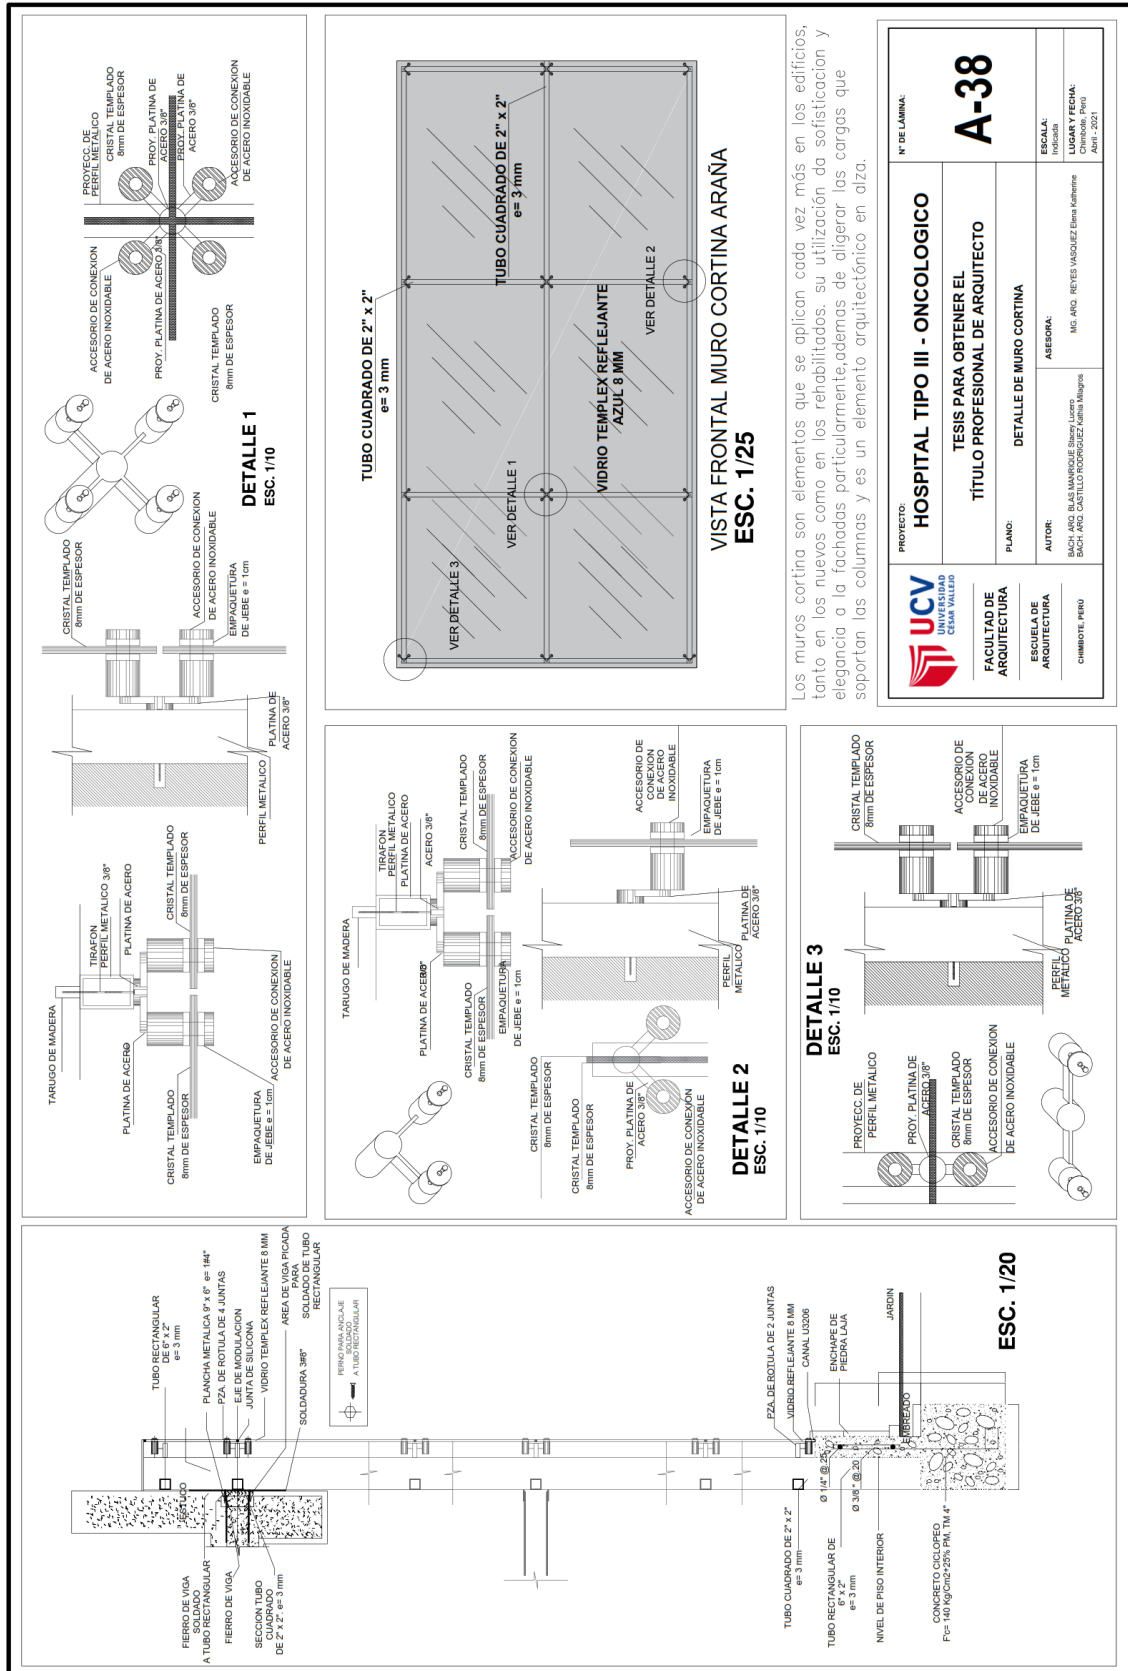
Plano de Detalle Constructivo – Muro Cortina
